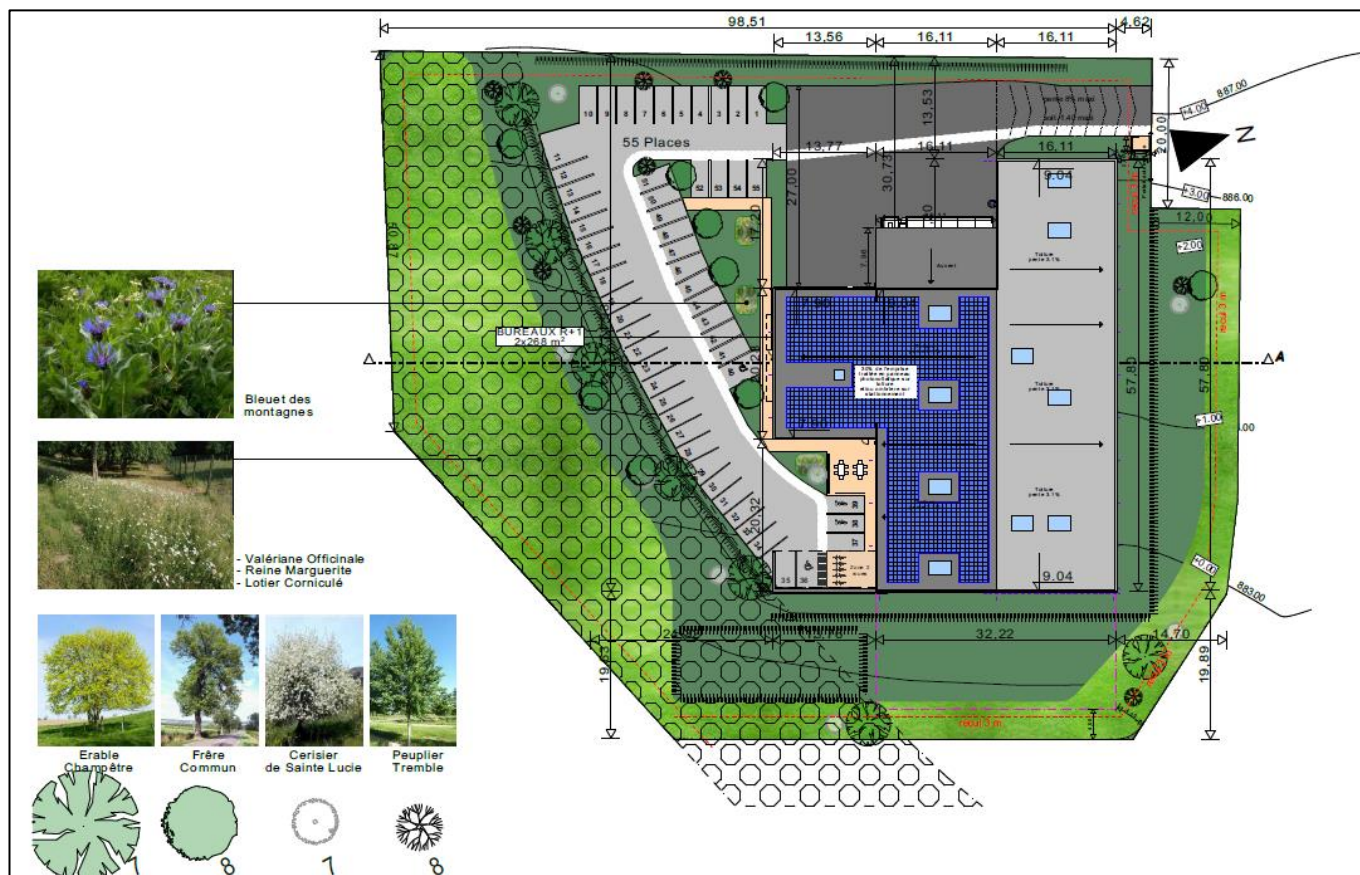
Extrait du plan de rez-de-chaussée – Atelier Renaud Balaj
